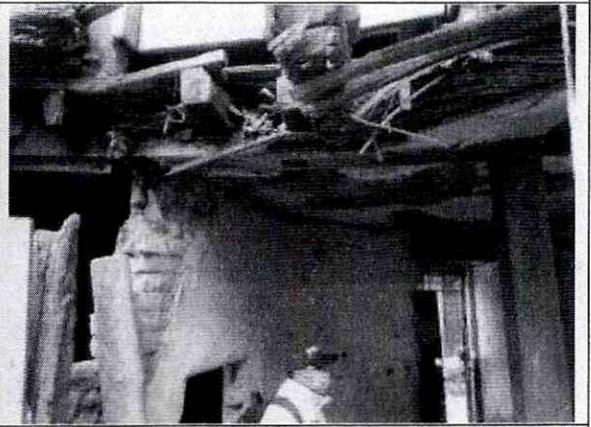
Detalle del segundo piso, se observa colapso parcial de cubierta.
